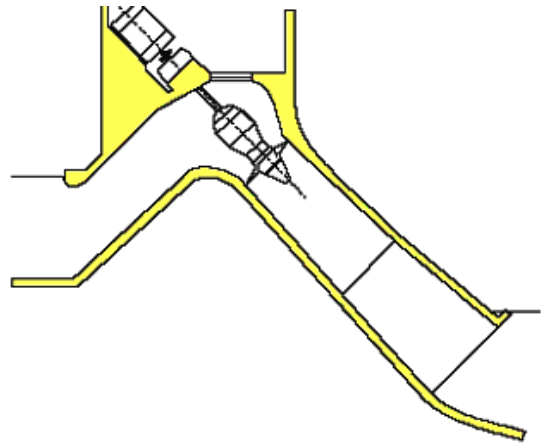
Coupe d'une installation de turbine Kaplan en siphon inversée
